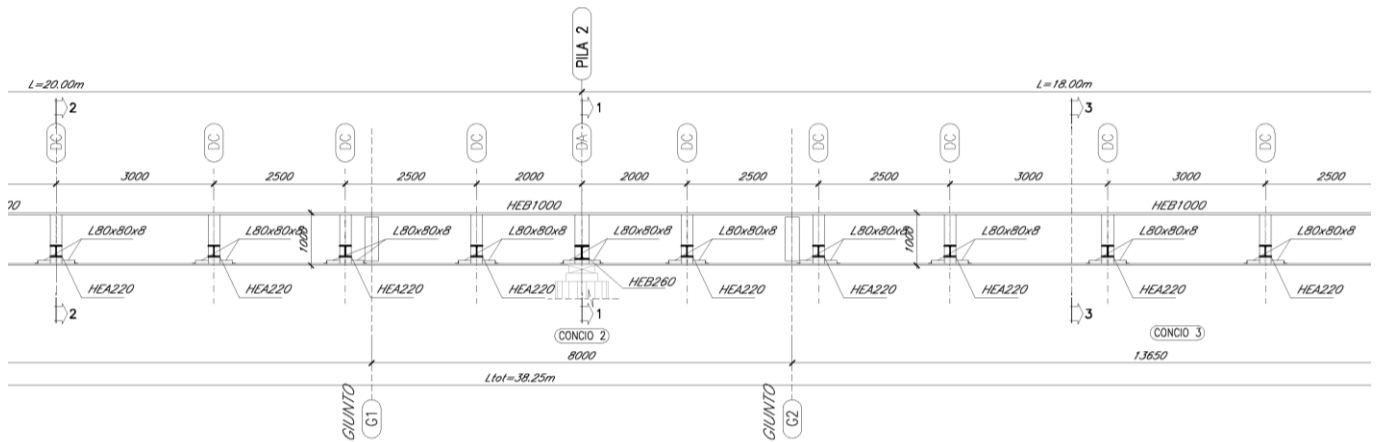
Sezione longitudinale impalcato in carpenteria metallica (stralcio) [mm]
